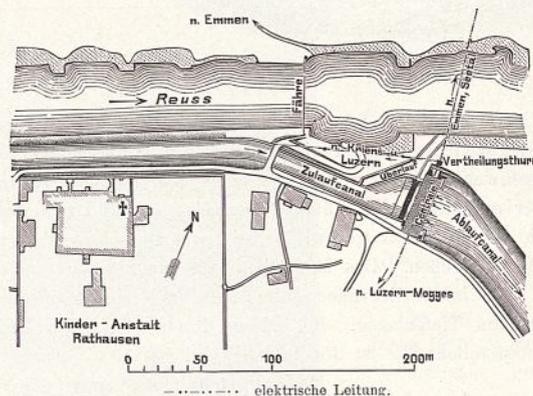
Rathausen. Lageplan des Kraftwerk.
